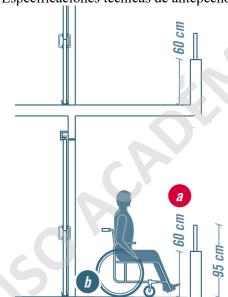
Especificaciones técnicas de antepecho en la vivienda.
